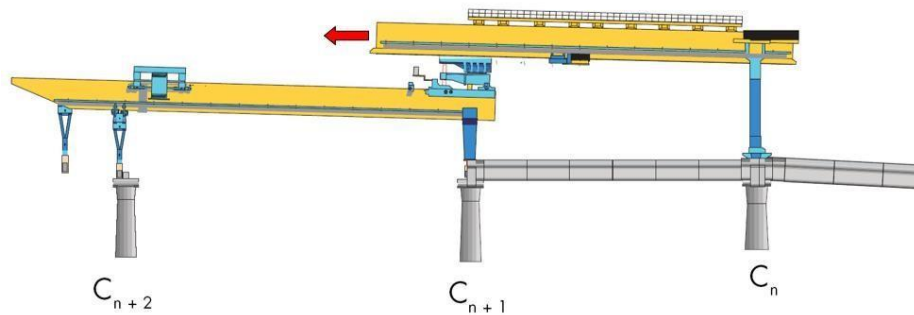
Avance de la viga lanzadora, Fase 1: avance de la viga superior sobre la viga inferior (1)
